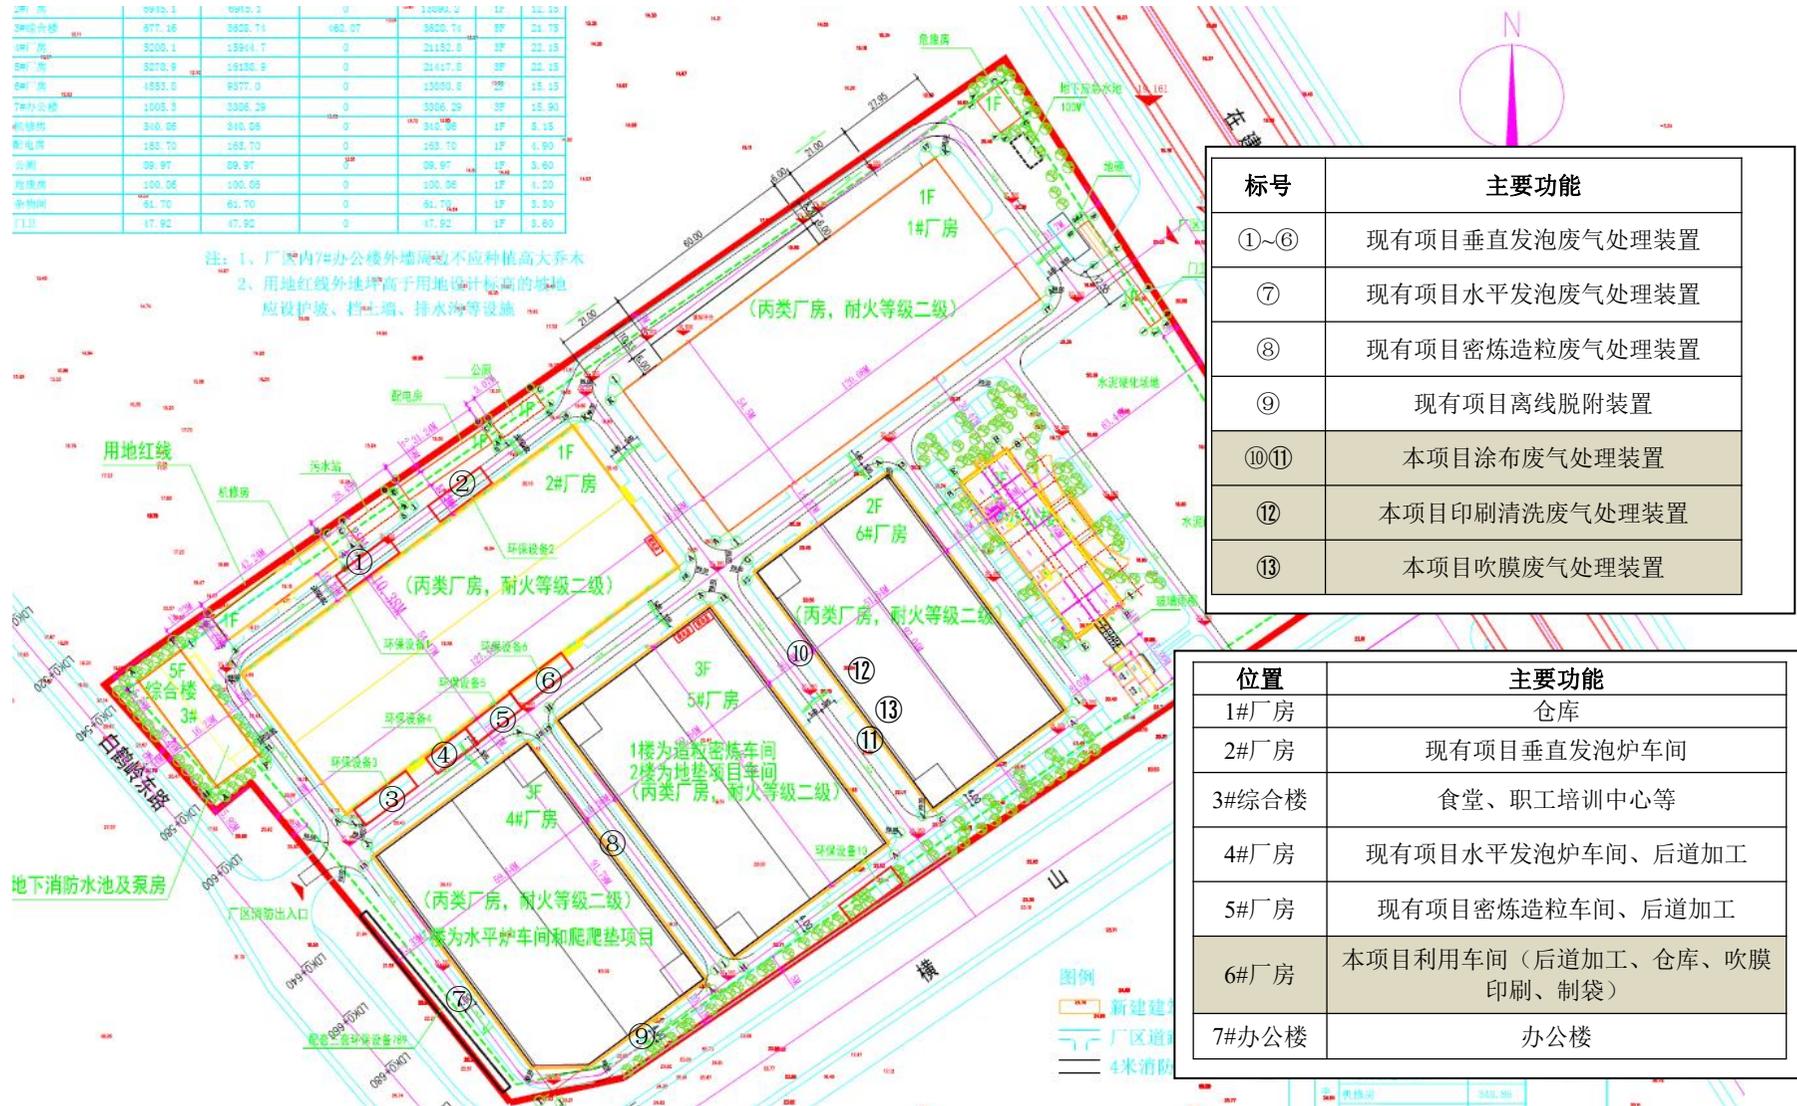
原环评设计厂区平面布置图（自有厂区）
